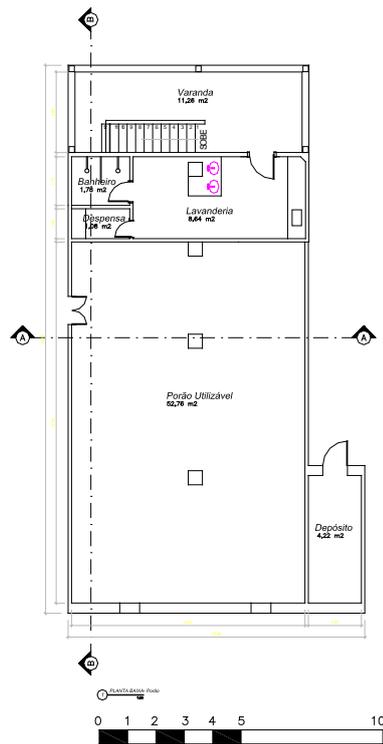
Planta porão - Casa Nadir Dutra Lopes
